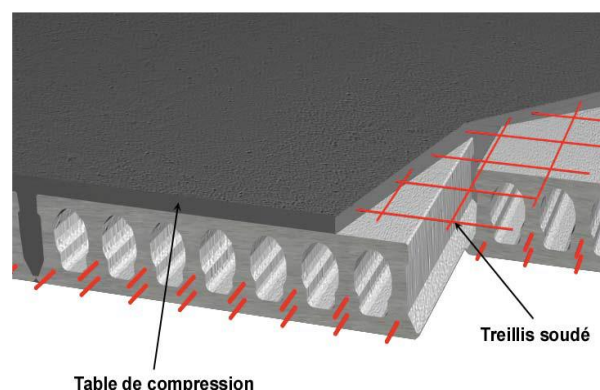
DALLE ALVEOLAIRE AVEC DALLE DE COMPRESSION
